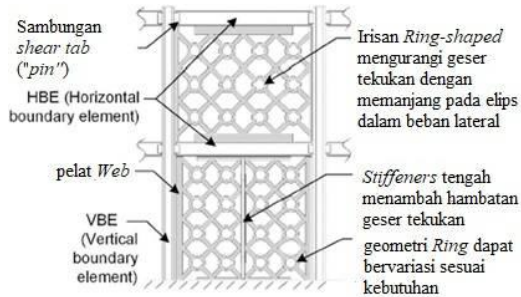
Steel Plate Shear Wall* (SPSW)
